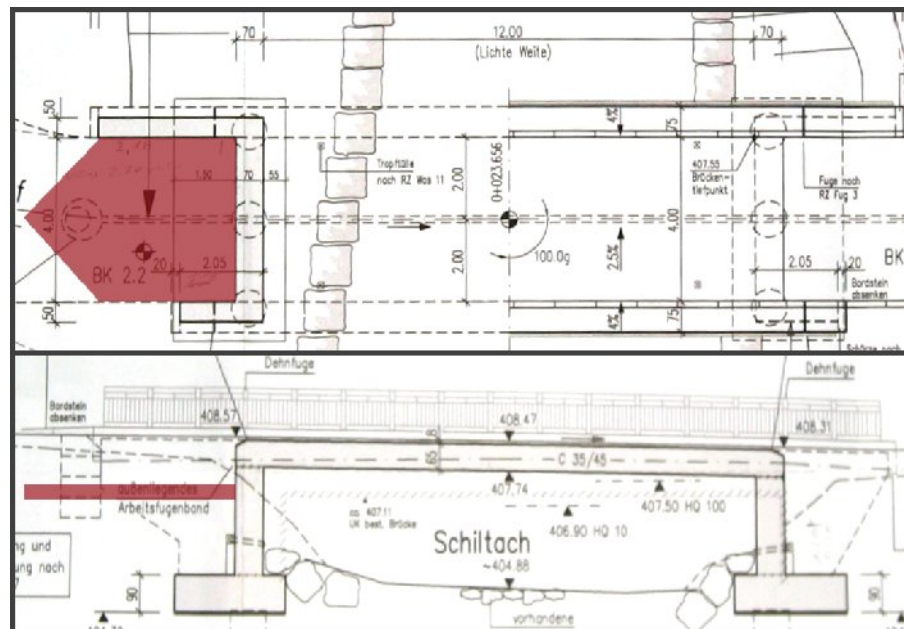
Grundriss- und Längsschnitt (Raubacher-Schulter: rot eingezeichnet)
